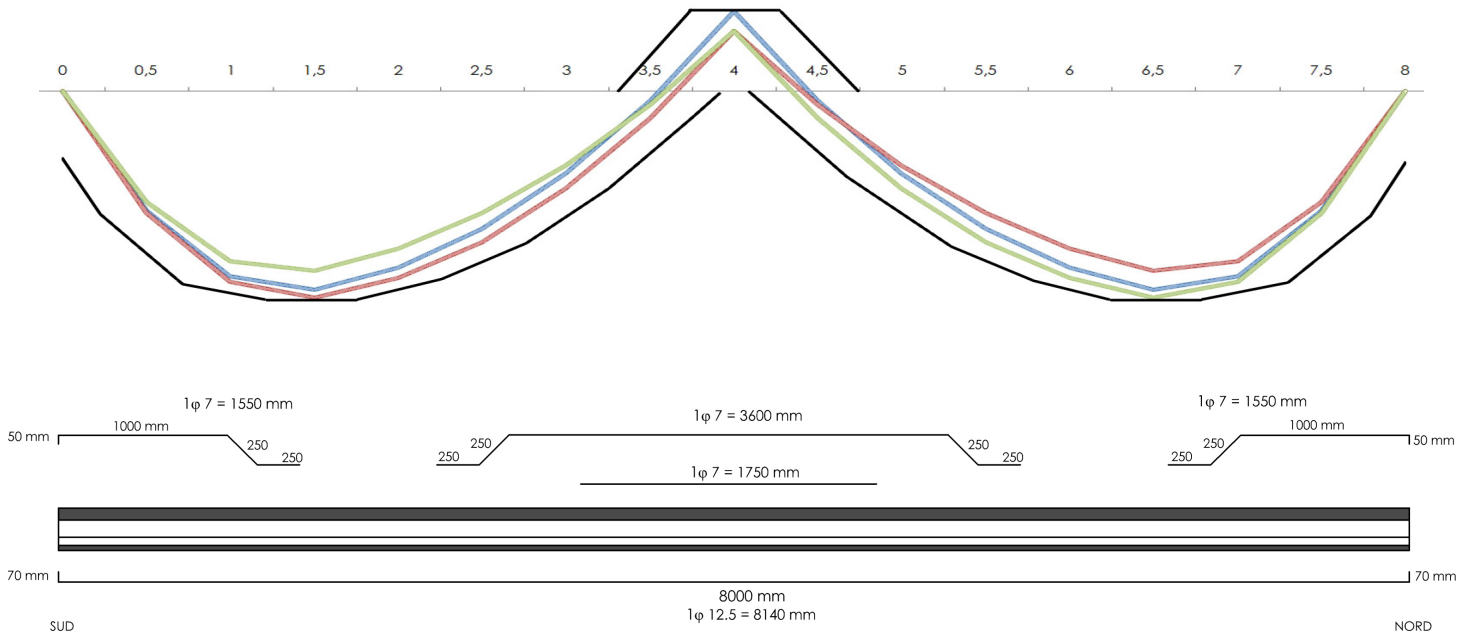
Tracciato delle armature nella soletta copertura
